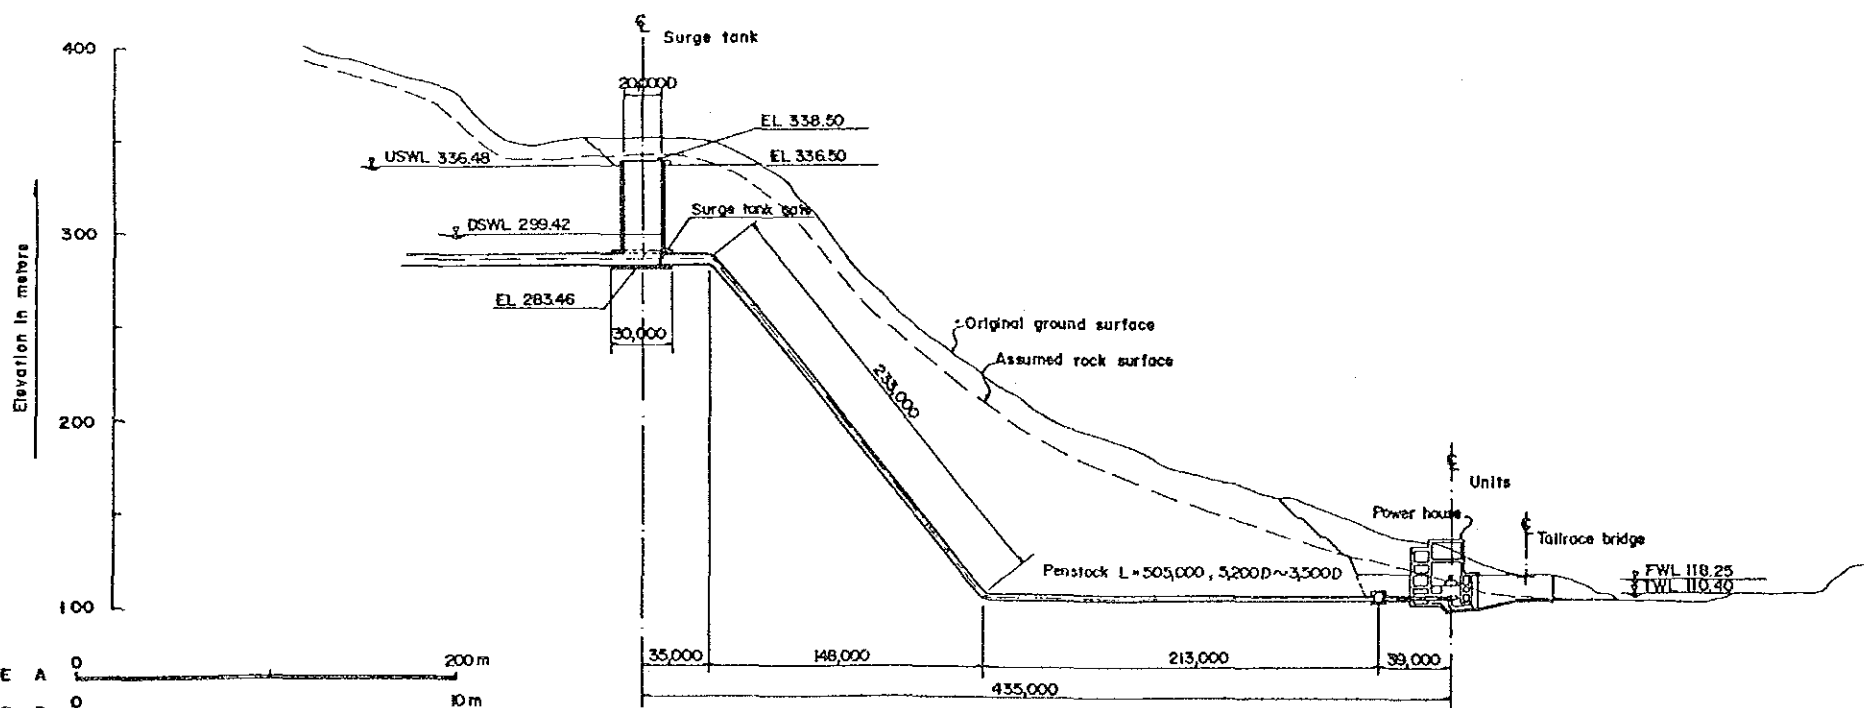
Salto Pilao (1) 計画の水路の平面図及び縦断図
